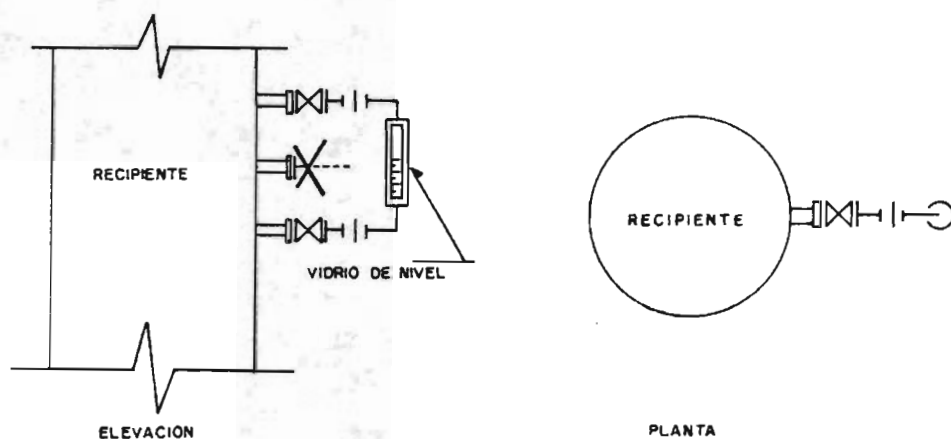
Vidrio de nivel y orientación de boquillas para su instalación.
